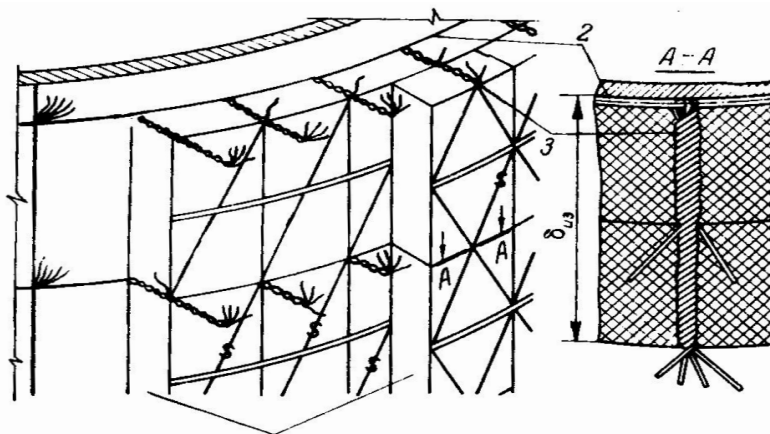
изоляция аппаратов жесткими теплоизоляционными плитами с креплением проволоочными стяжками.
